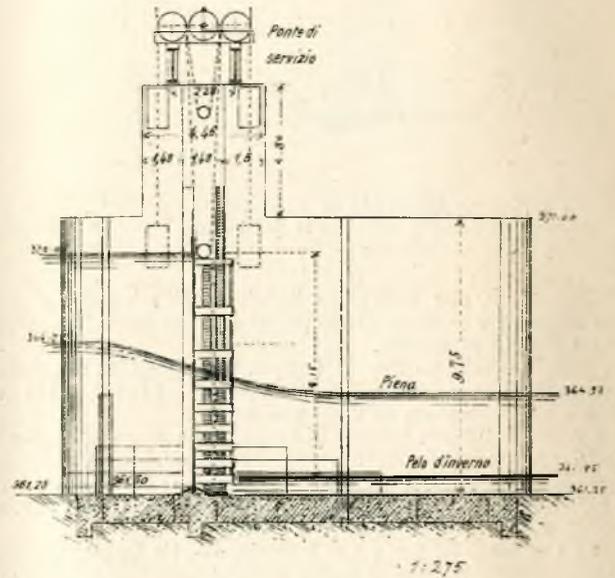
Impianto di Chèvres. — Sezione della diga.
